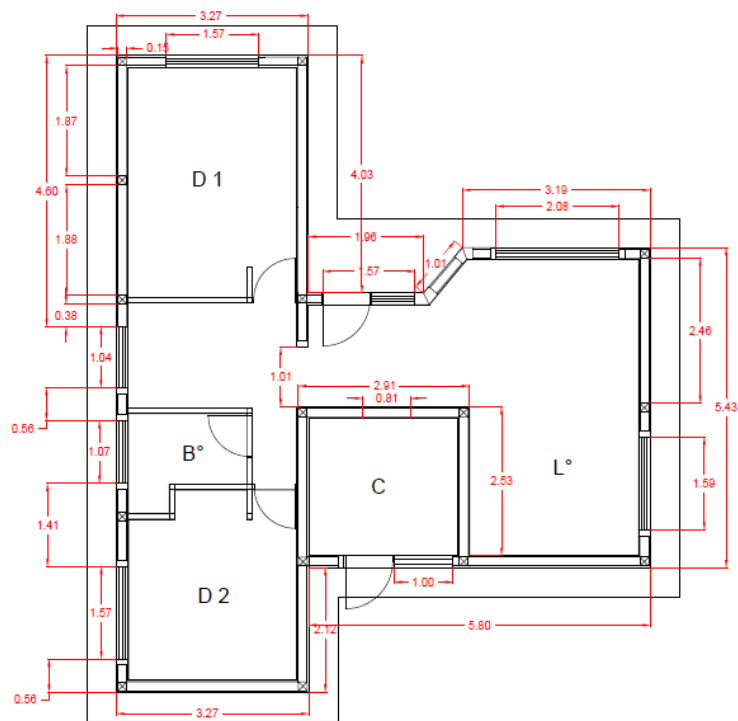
Planos de planta con rectificación de medidas en terreno – Fuente: Elaboración propia
